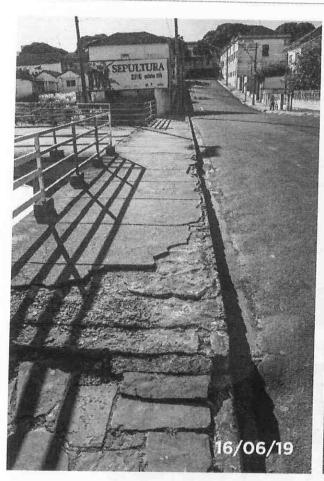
Vista do Passeio, com o desplacamento de concreto, trincas, vegetação e depressão no acesso ao passeio.
